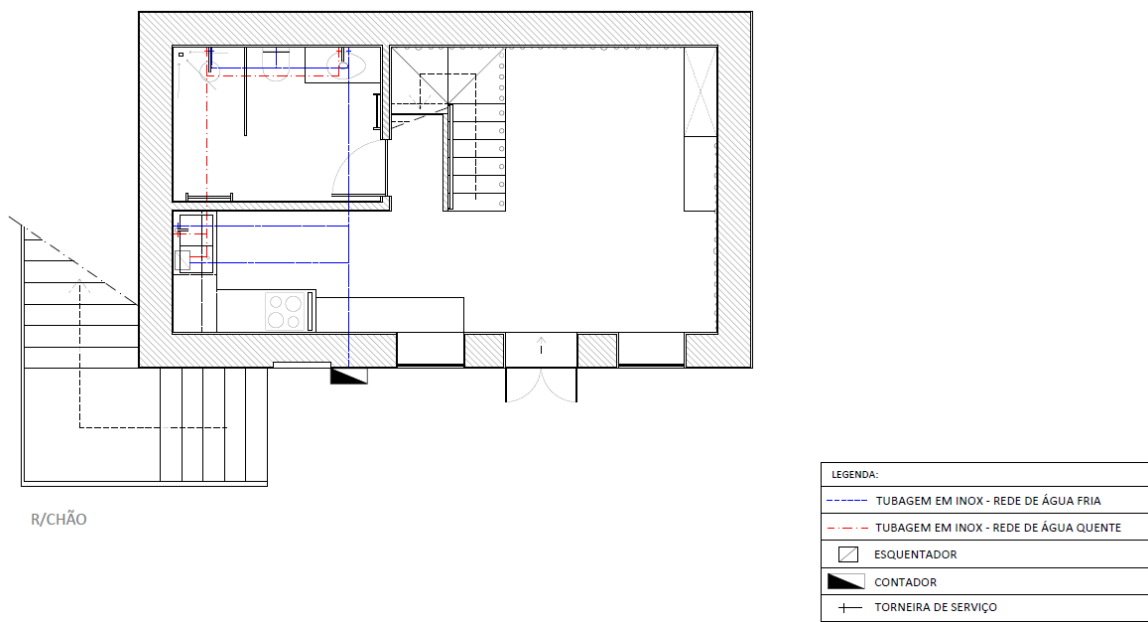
Planta de Rede de Águas, Alojamento Til, Piso 1.
